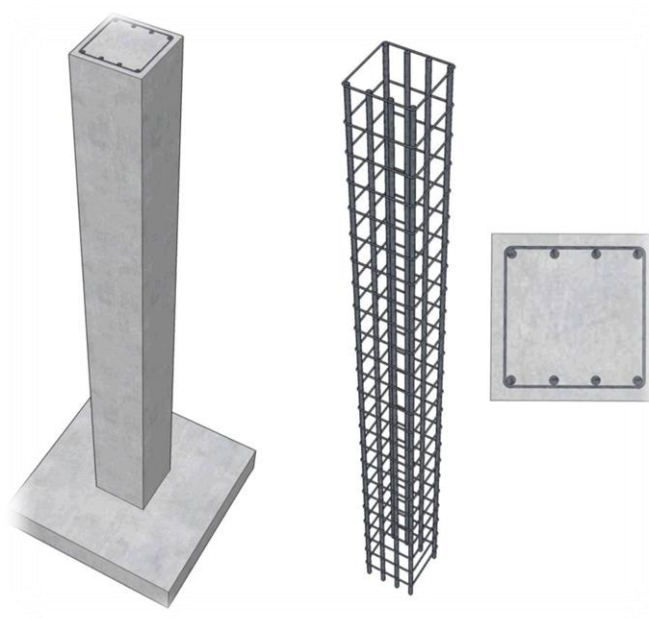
Залізобетонна колона з високоміцними арматурними стрижнями
